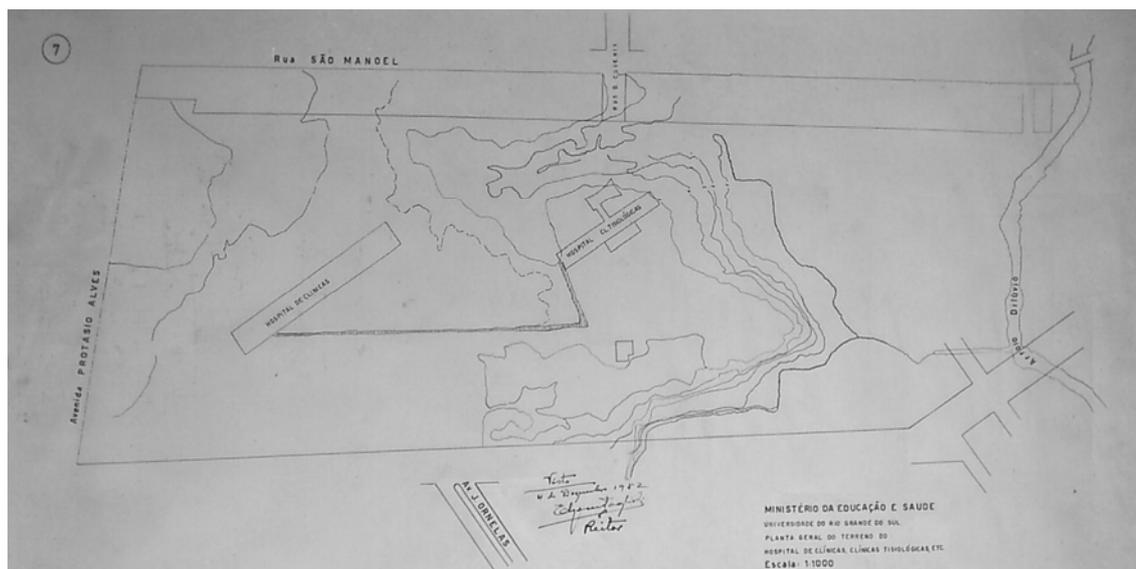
planta geral do terreno do Centro Médico – 1952 (Arquivo da Sub-Prefeitura do *Campus Saúde*)
